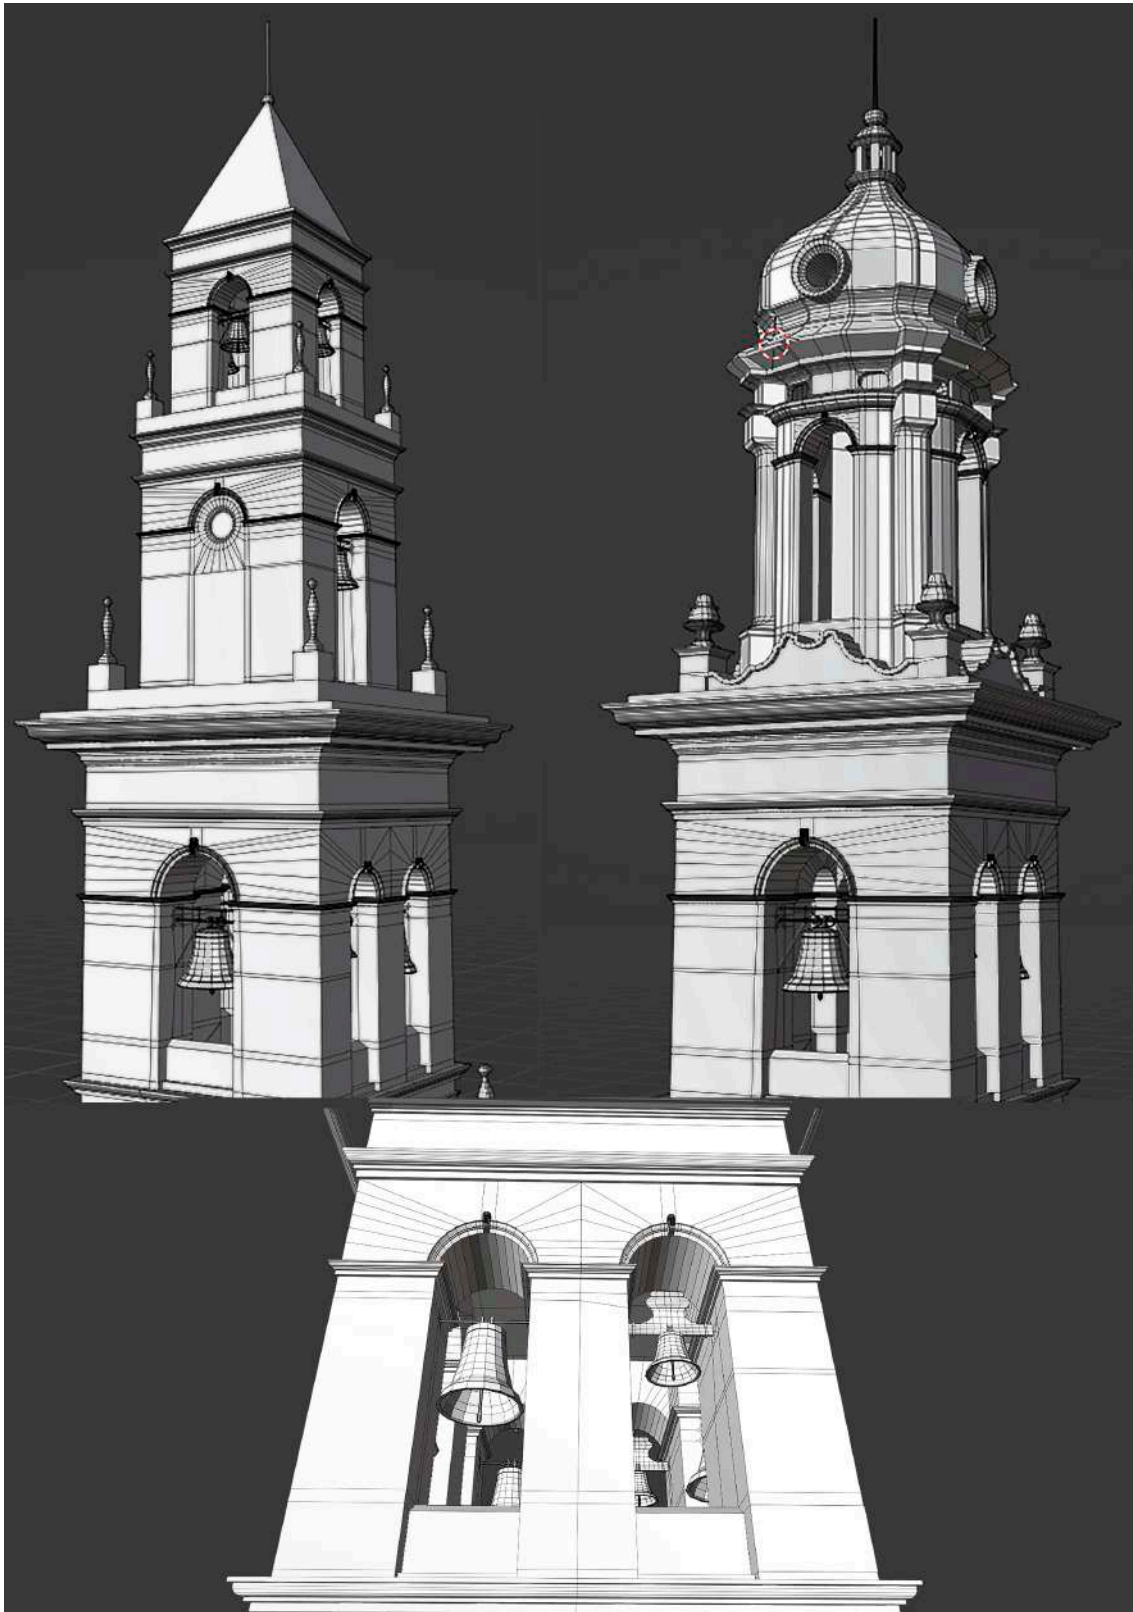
Detalle de la torre en sus distintas etapas modelado en Blender. Aquí se aprecian detalles de las campanas y los elementos constructivos.
